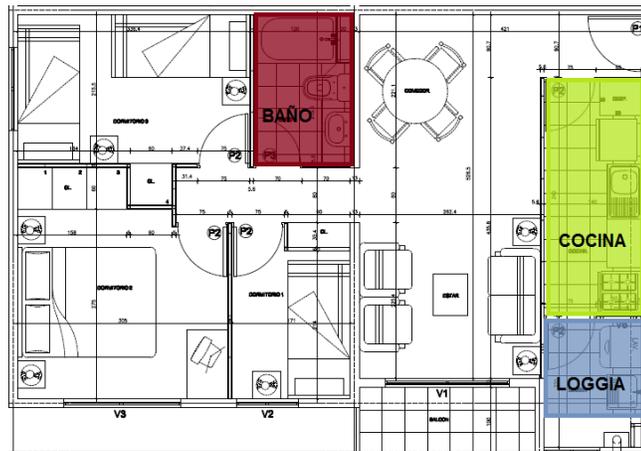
Planta de arquitectura, vivienda Pedro León Gallo Sur I.
